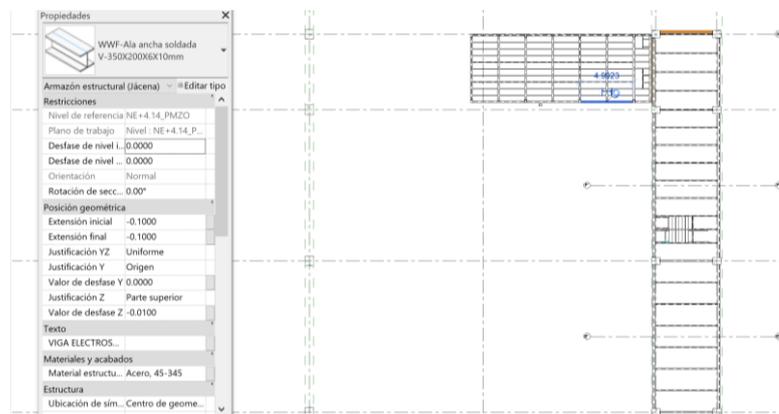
Plano de estructura entrepiso área administrativa, fuente Modelo estructural propia.
